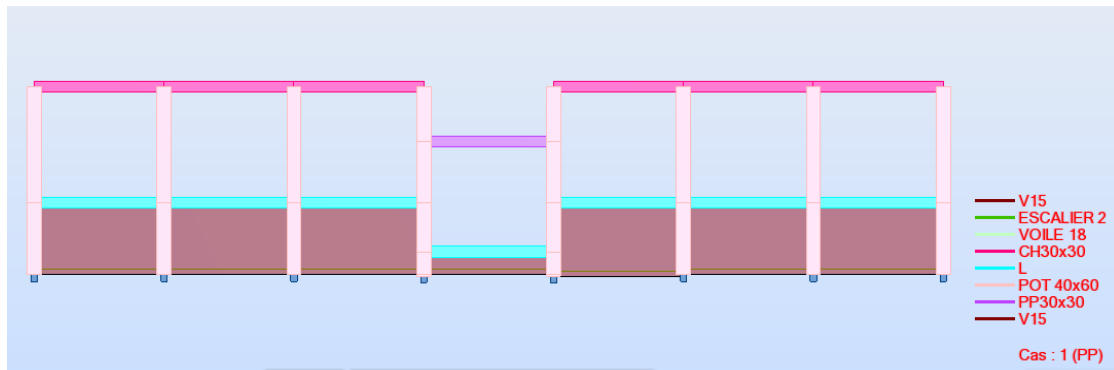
schéma des voiles périphériques longitudinales avec les poteaux et les poutres
